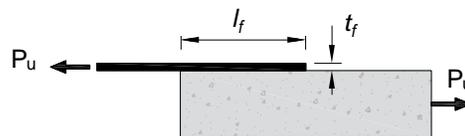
Ensaio de corte simples de PRFC aderido ao concreto.
